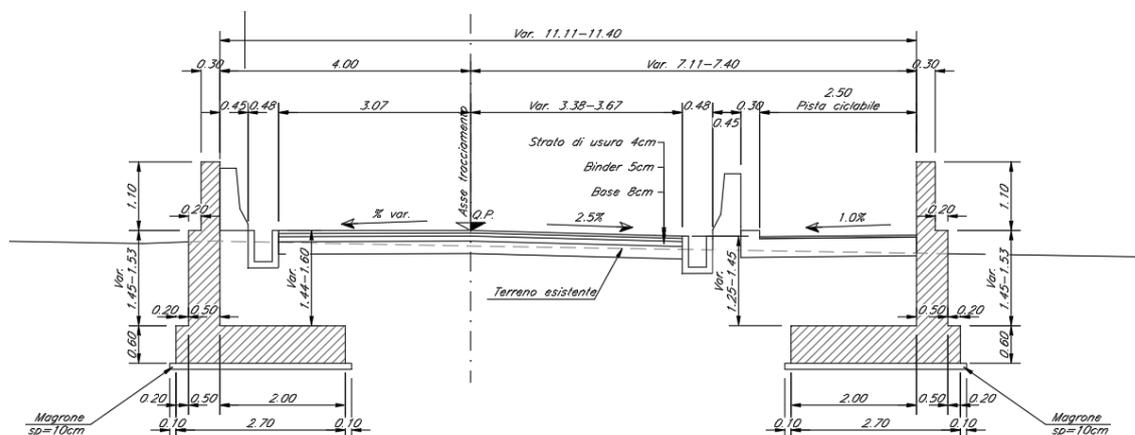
Sezione trasversale concio 1 ovest, in corrispondenza dell'inizio della rampa
